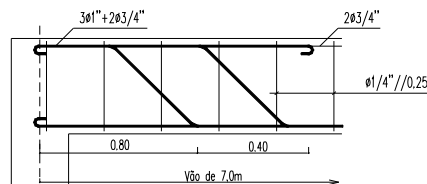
Insuficiente amarração das armaduras principais no nó.
